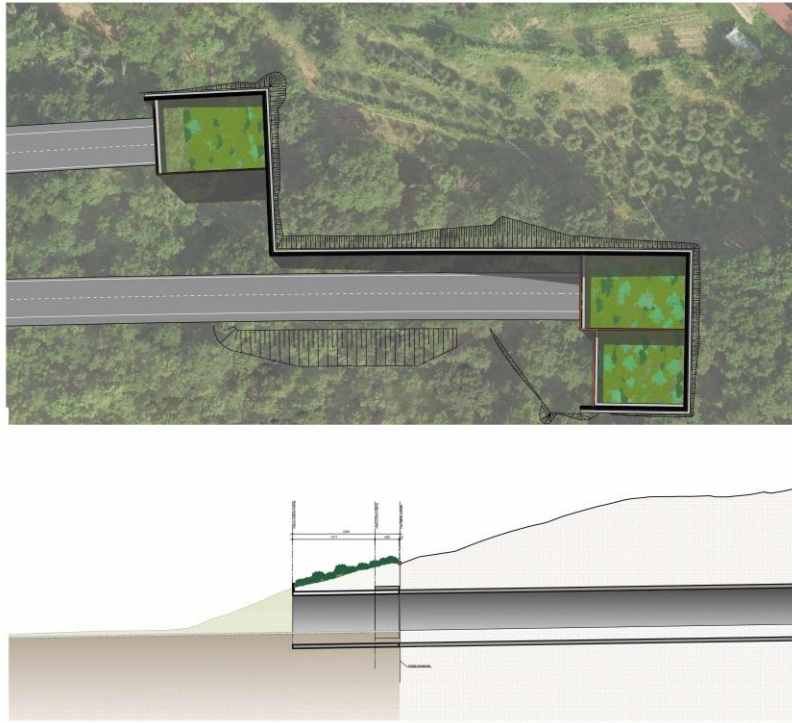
Planimetria e prospetto galleria Le Ville (imbocco ovest)
